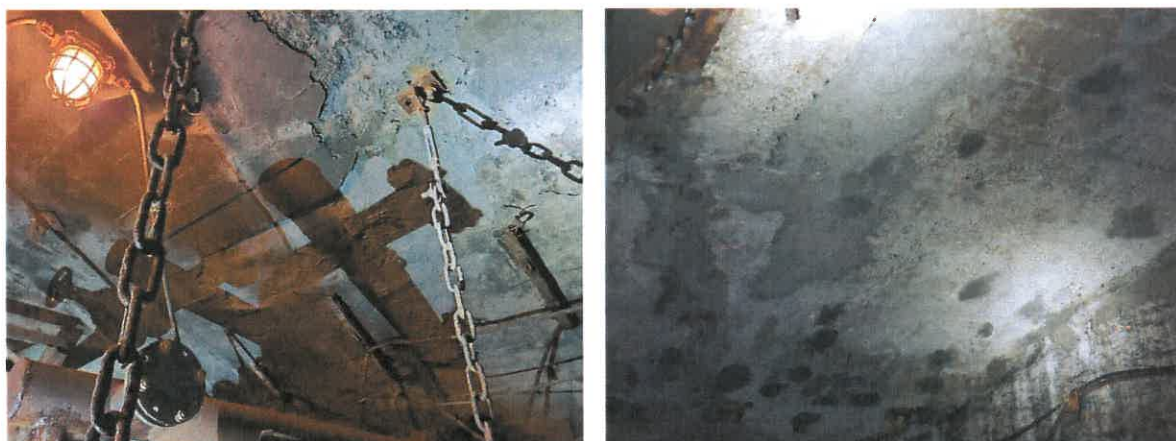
Belka stropowa żelbetowa podpierająca strop na poziomie -52,300m.
